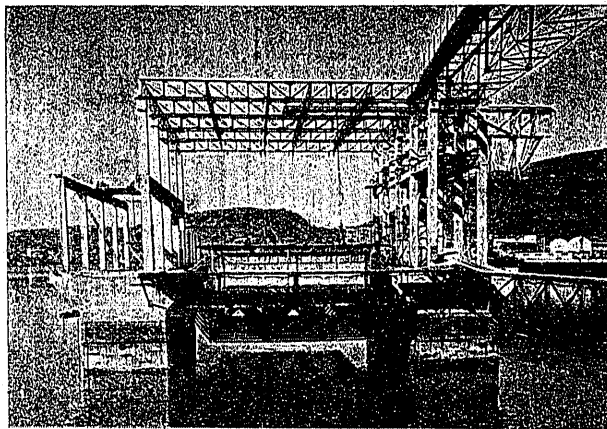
Vista del taller de construcción de cajones durante el montaje. Encima de una plataforma metálica, suspendida de los dos cajones fondeados en primer lugar, se procede primeramente al hormigonado de un gánguil para la escollera y después a la ejecución del tercer cajón pequeño, y que con los anteriores completa la infraestructura del taller.
